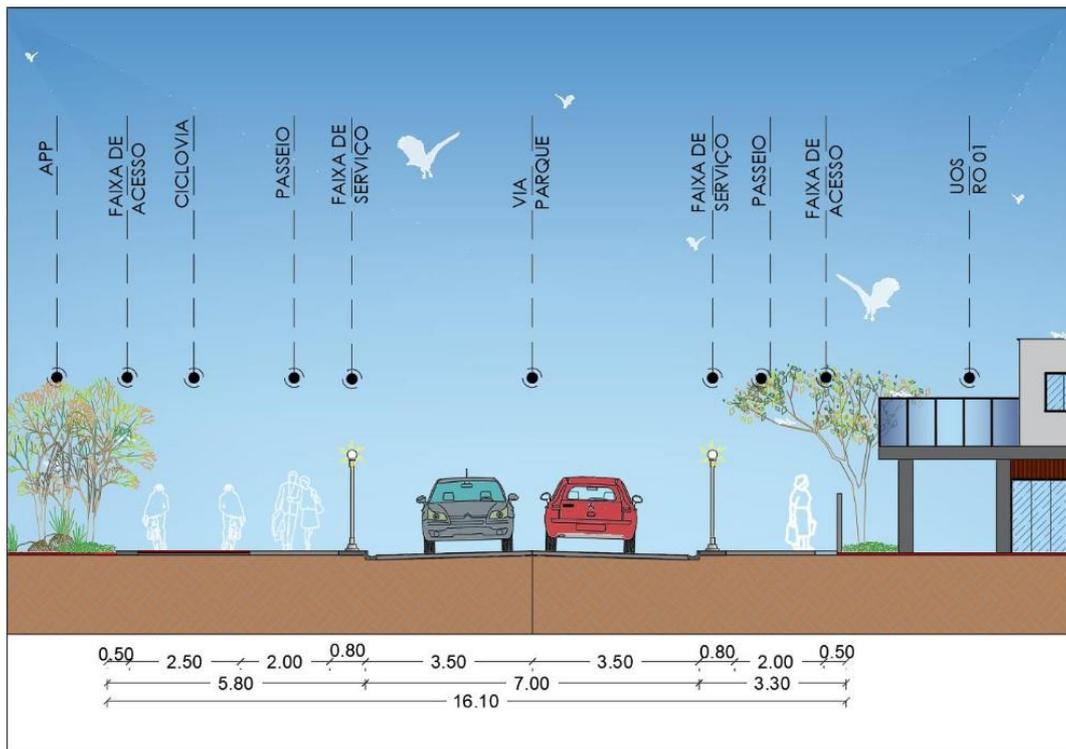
Perfil viário P5 - Via de Circulação de Vizinhança 2 (Via Parque). Fonte: MDE 241/2022.
